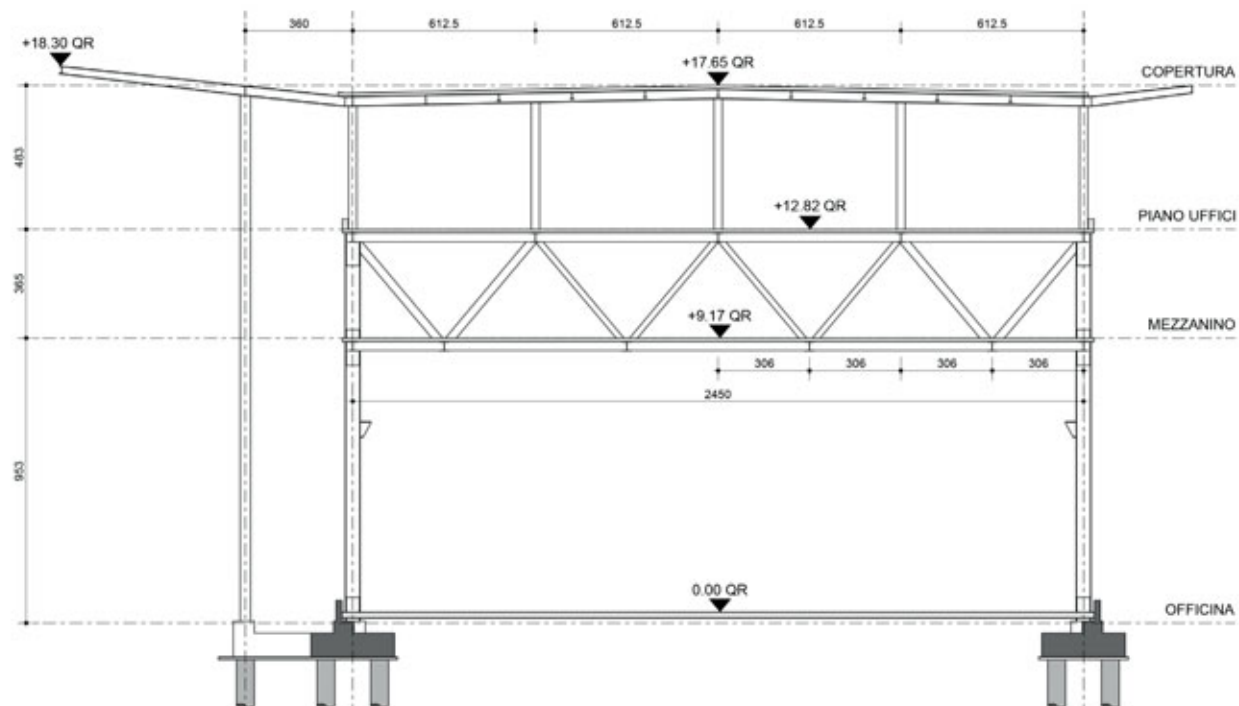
Sezione trasversale dell'edificio © Redesco Progetti
